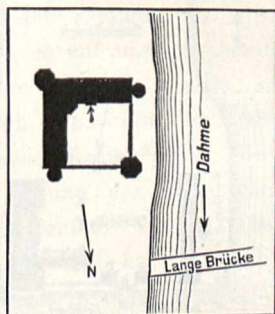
Vermutlicher Lageplan des um 1570 erbauten Schlosses.
